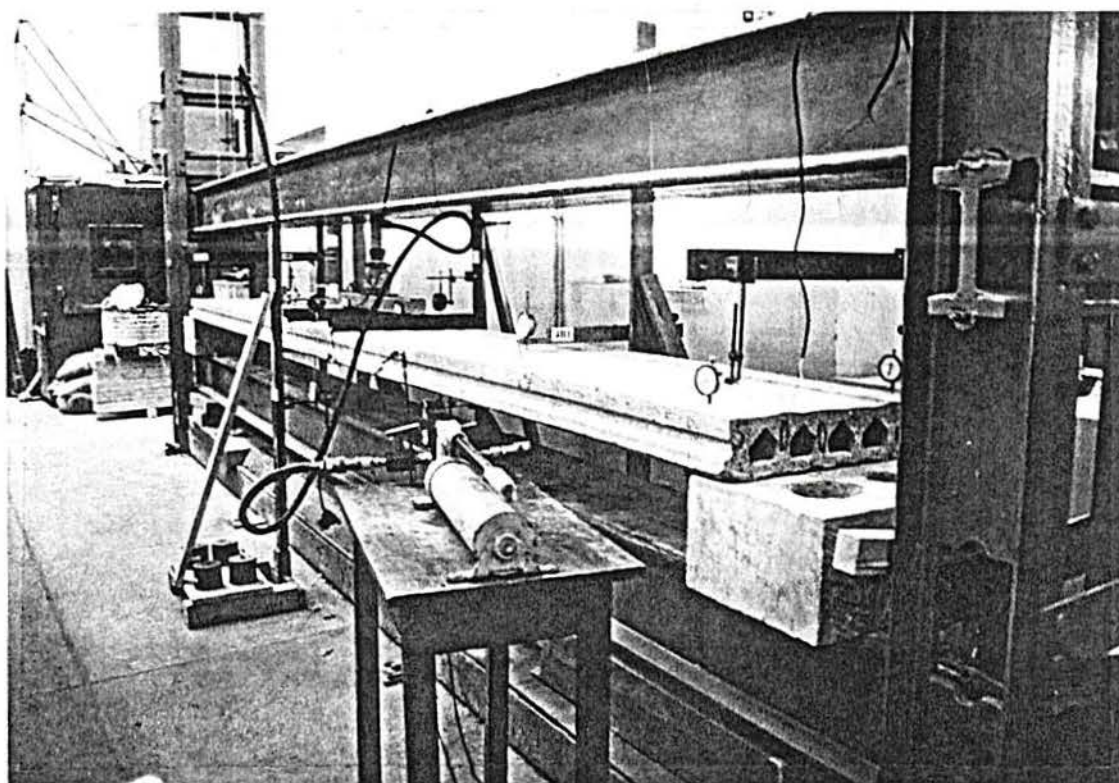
Vista do protótipo B1, instrumentado para o ensaio de carregamento até a ruptura
